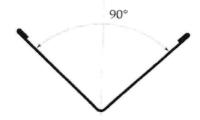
Coupe transversale d'un élément d'ossature métallique « Cornière d'angle »
